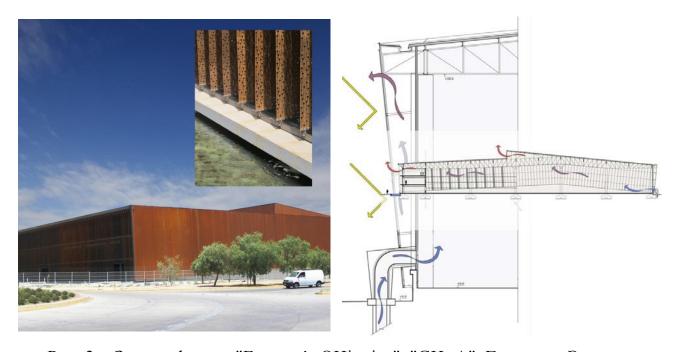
Здание фирмы "Ferretería OHiggins", "GH+A". Гильермо Эвиа. Общий вид. Фрагмент железных жалюзи и система кондиционирования
